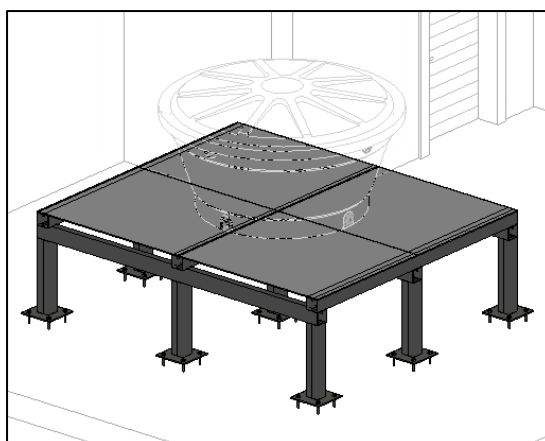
Suporte p/ Caixa D'água – Guichê – Planta
